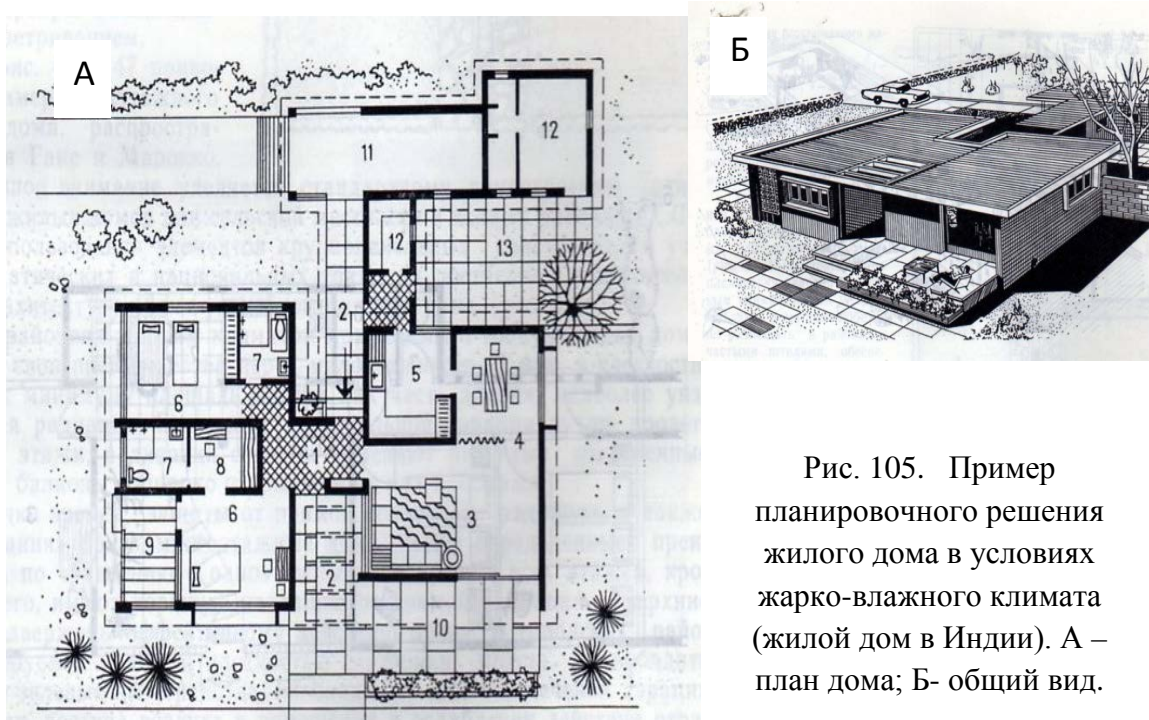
Пример планировочного решения жилого дома в условиях жарко-влажного климата (жилой дом в Индии). А – план дома; Б- общий вид.
